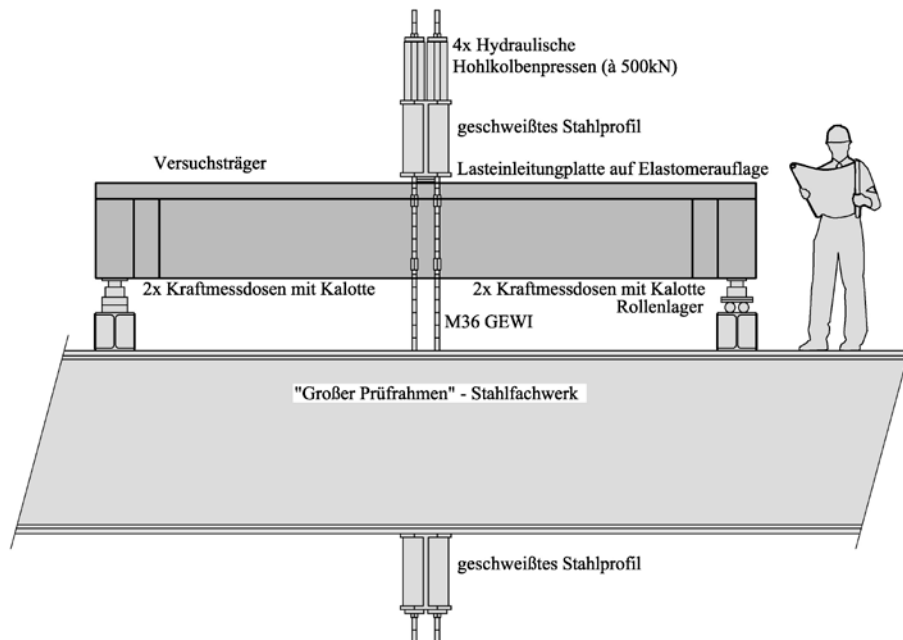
Versuchsaufbau der Querkraftversuche an Spannbetonträger mit geringem Schubbewehrungsgrad
